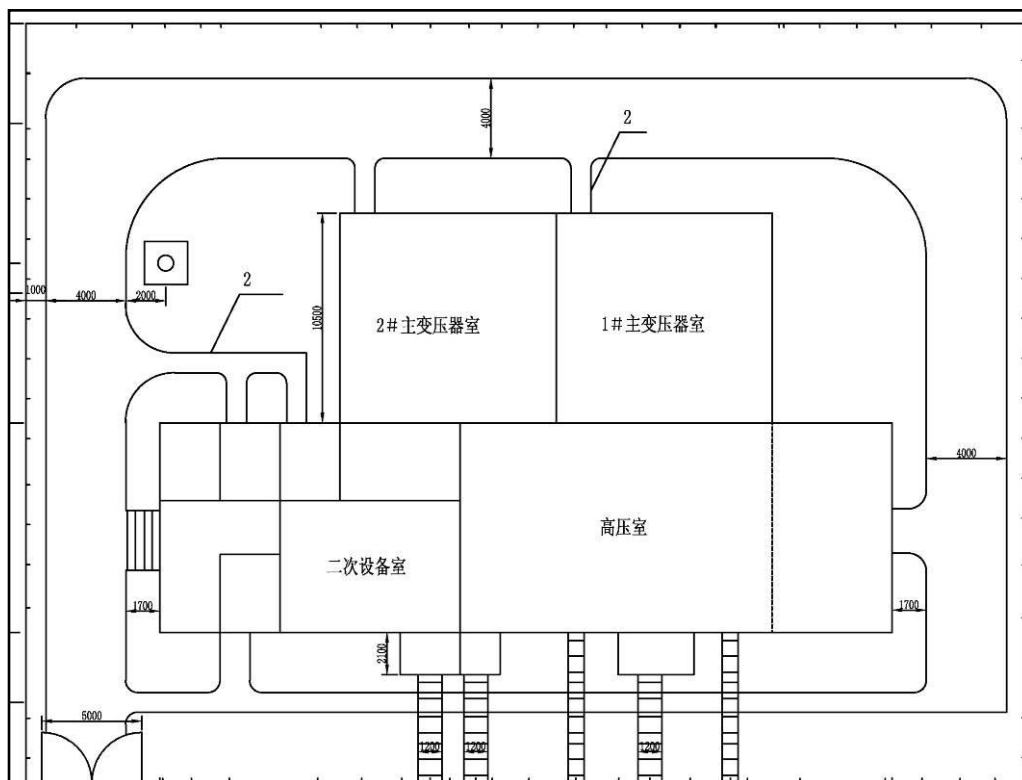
本工程新建 110kV 主变电所总平面布置图
